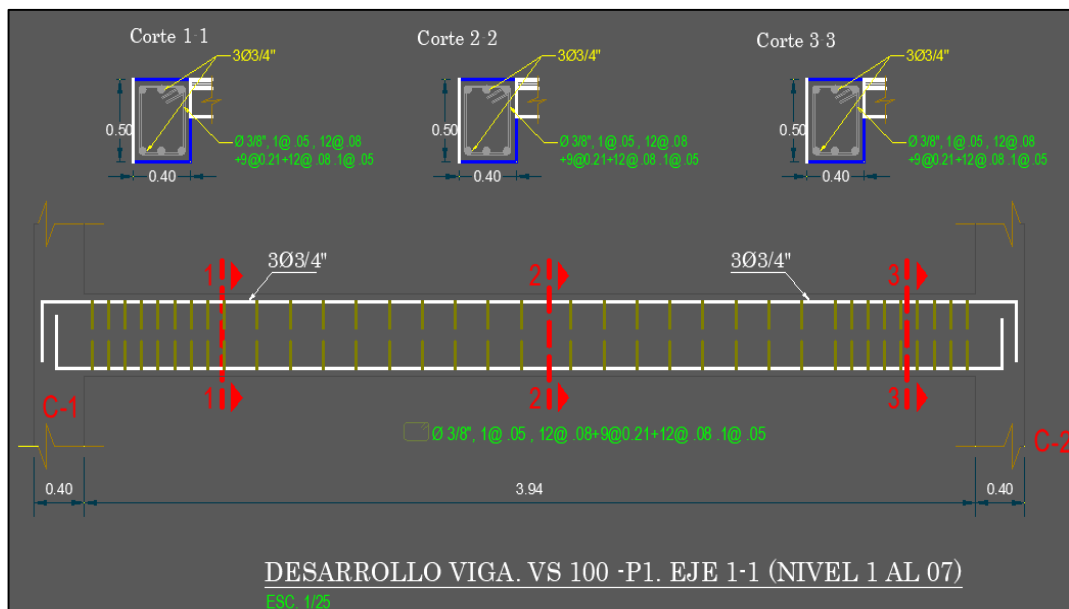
Planos en detalle de la viga Vs. P1. Mayor detalle ver anexo (planos vigas)
